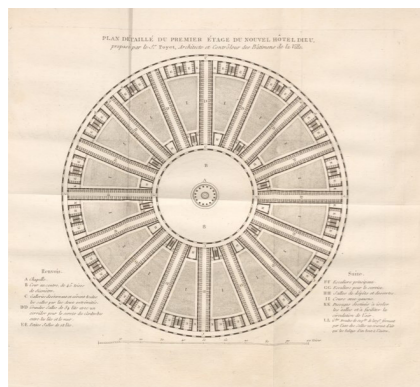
Poyet. Plan Detaille du Nouvel Hotel-Dieu, 1785
